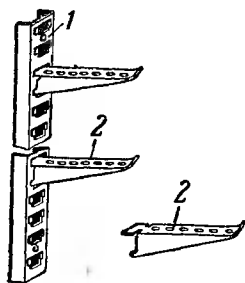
Конструкция для прокладки кабелей вдоль стен.
